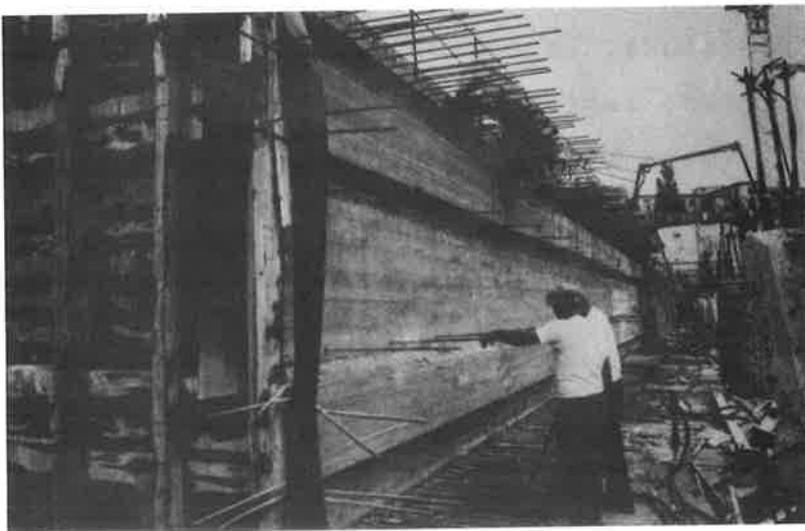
Particolare del faccia vista di un conccio gettato a cielo aperto. Il getto è stato eseguito a tutta parete evitando riprese di getto e giunti freddi.
